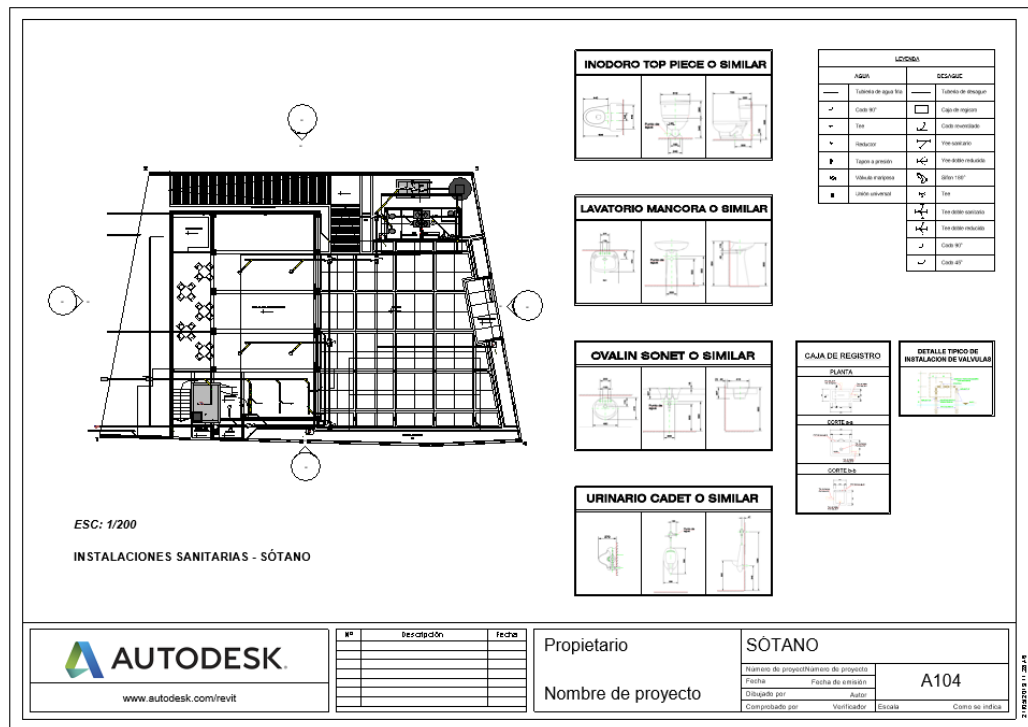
Plano de planta sótano - Instalaciones sanitarias. Fuente: Autor.
